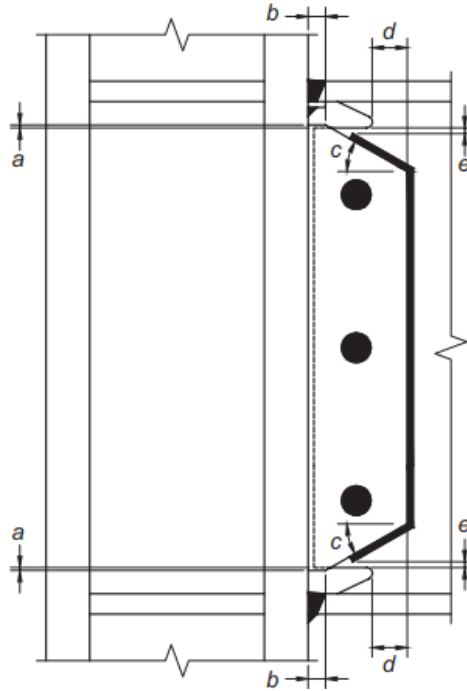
Detalles generales de la conexión alma de viga-a-aleta de columna
